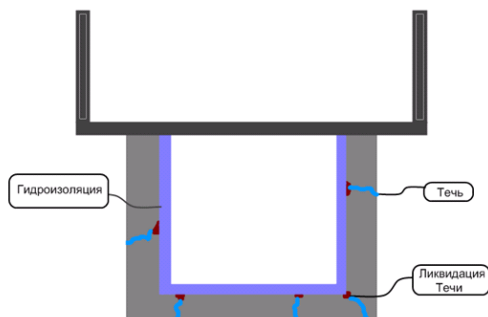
Гидроизоляция гаража изнутри помещения
